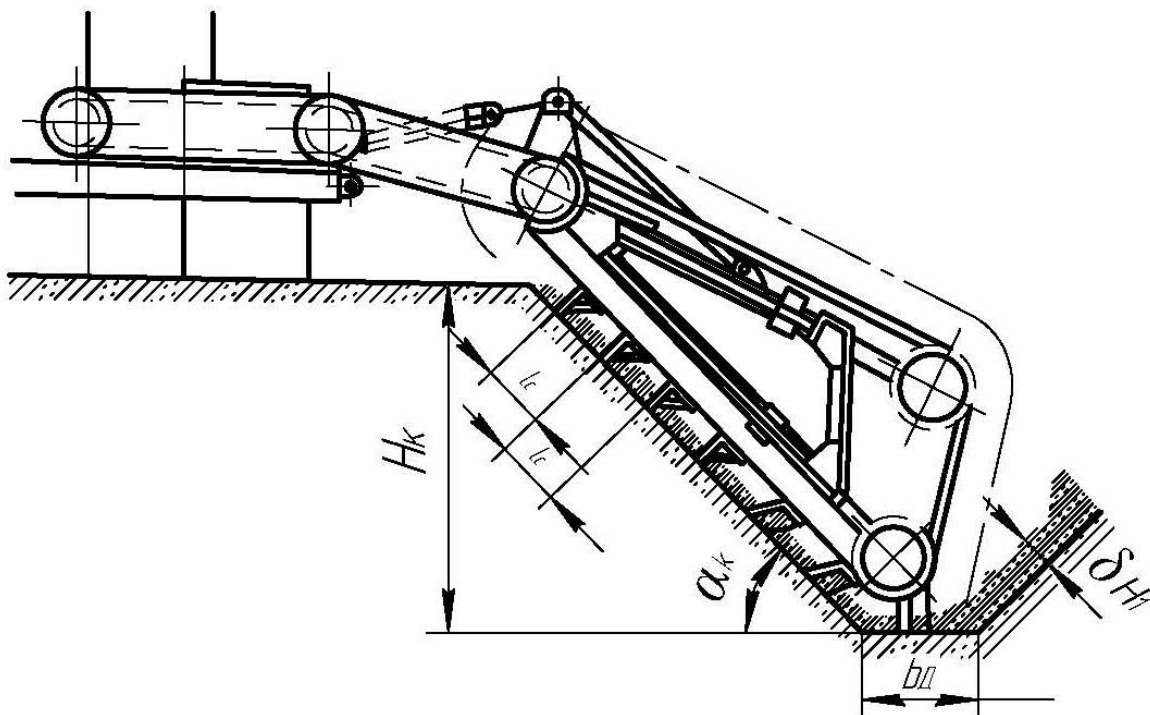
Схема машины со скребковым рабочим органом поперечного копания для очистки дна и одного откоса канала, работающим по раздельной схеме (тип 3)
